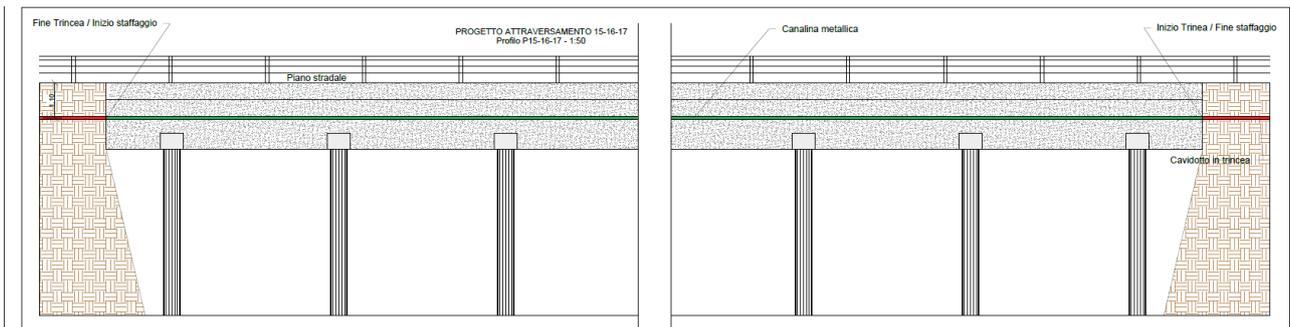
Attraversamenti n.15, 16, 17 – Sezione tipologica attraversamento mediante staffaggio su ponte
